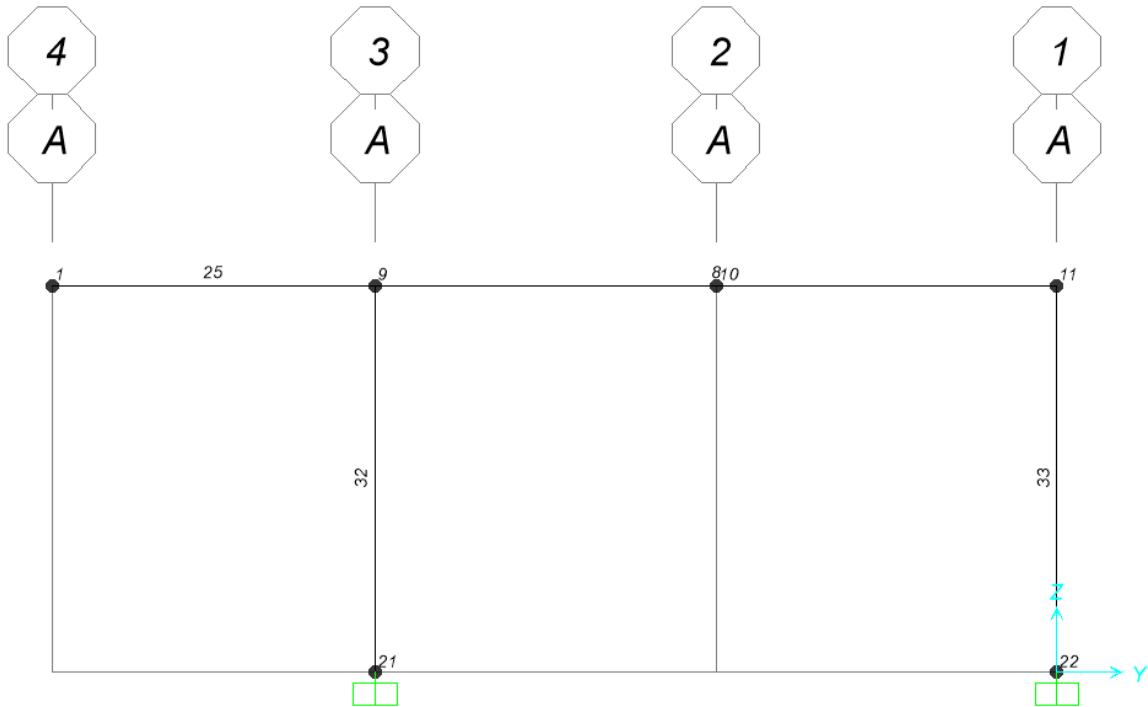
Vista in sezione modello struttura in elevazione –Filo A - numerazione elementi frame e joint
